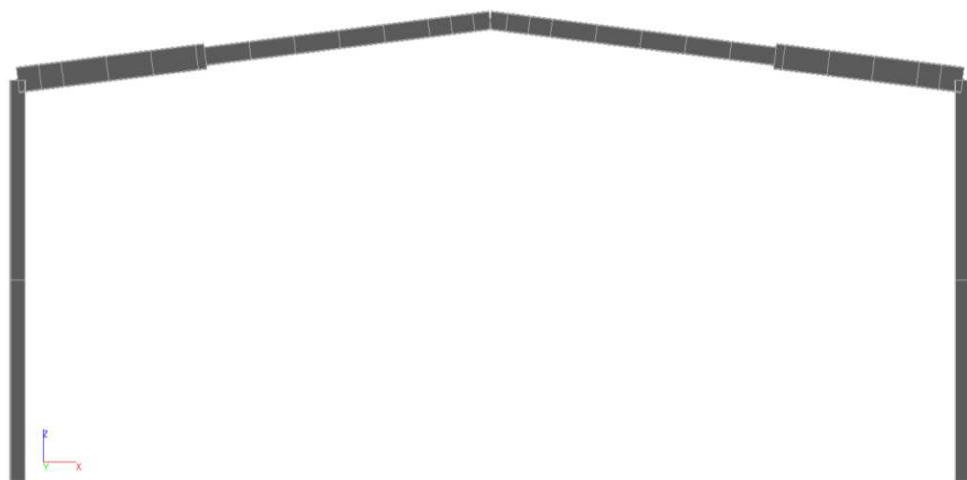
Расчётная схема поперечника здания в пространстве
